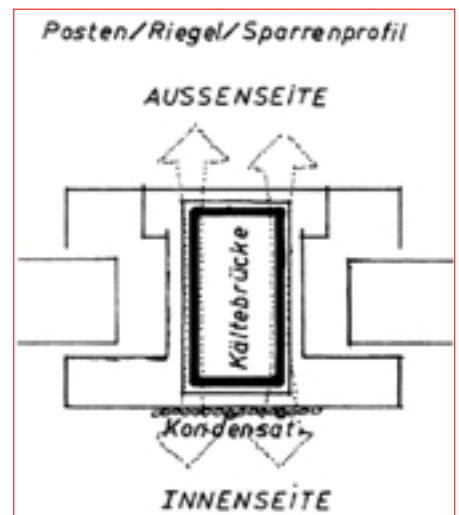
Hier wird gezeigt, wie Pfostenprofile aus dem Fensterbau als Dachsparren verwendet wurden
